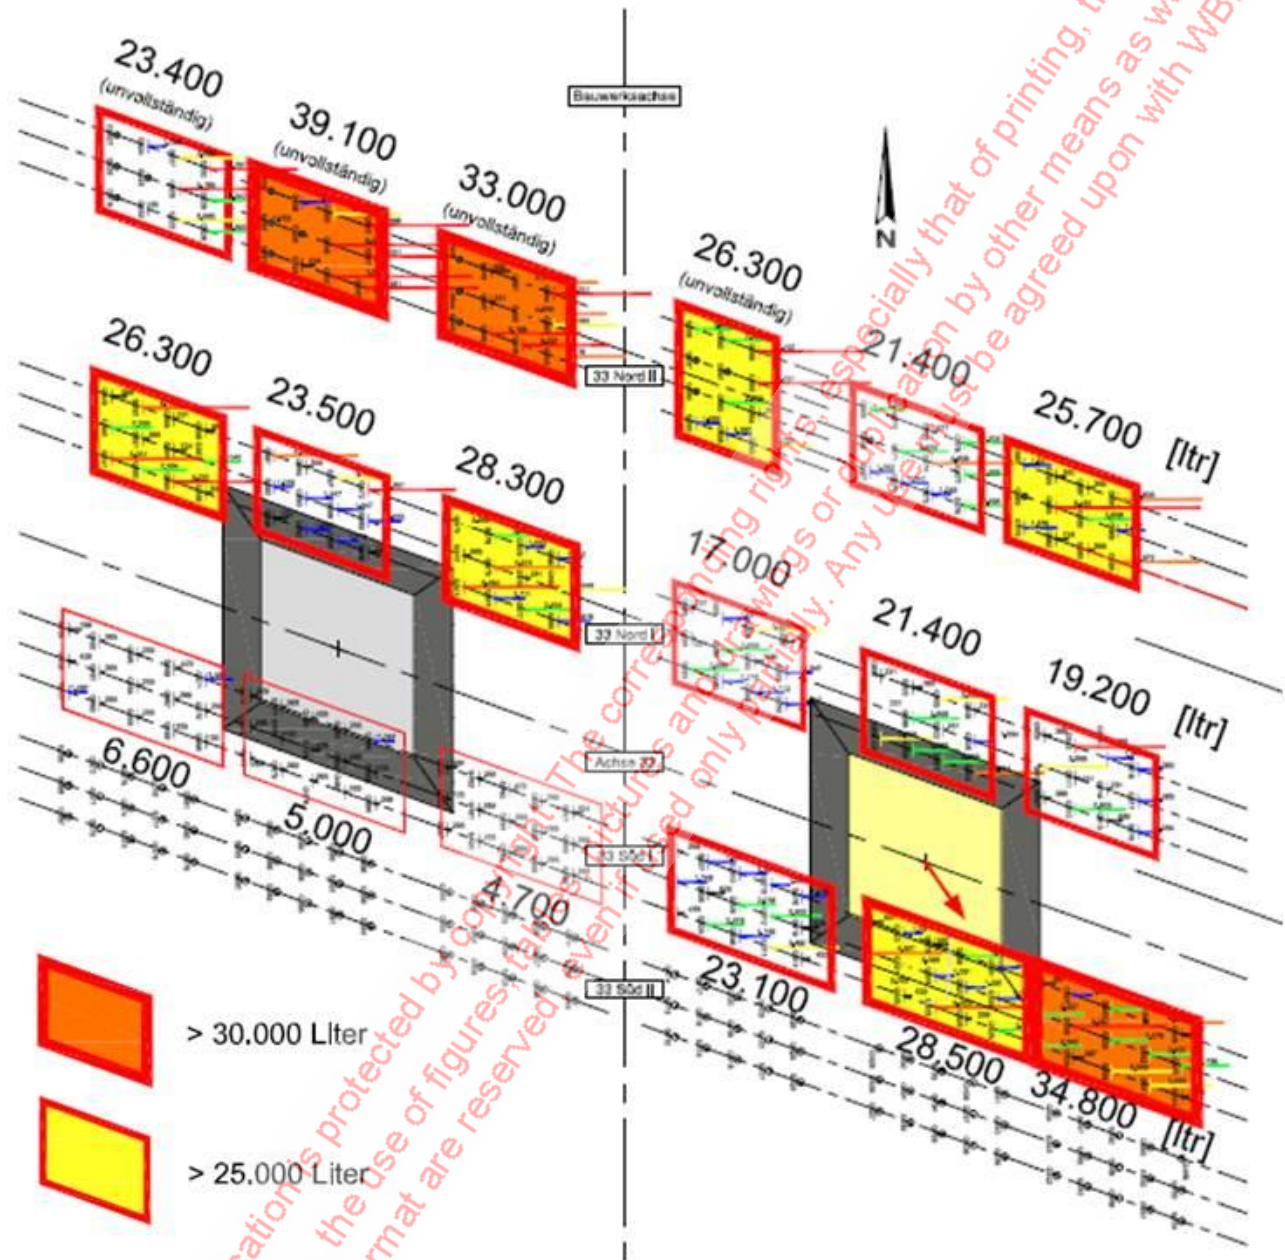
Lageplan Achse 33 mit GEWI-Pfahlgruppen und Verpressmengen
